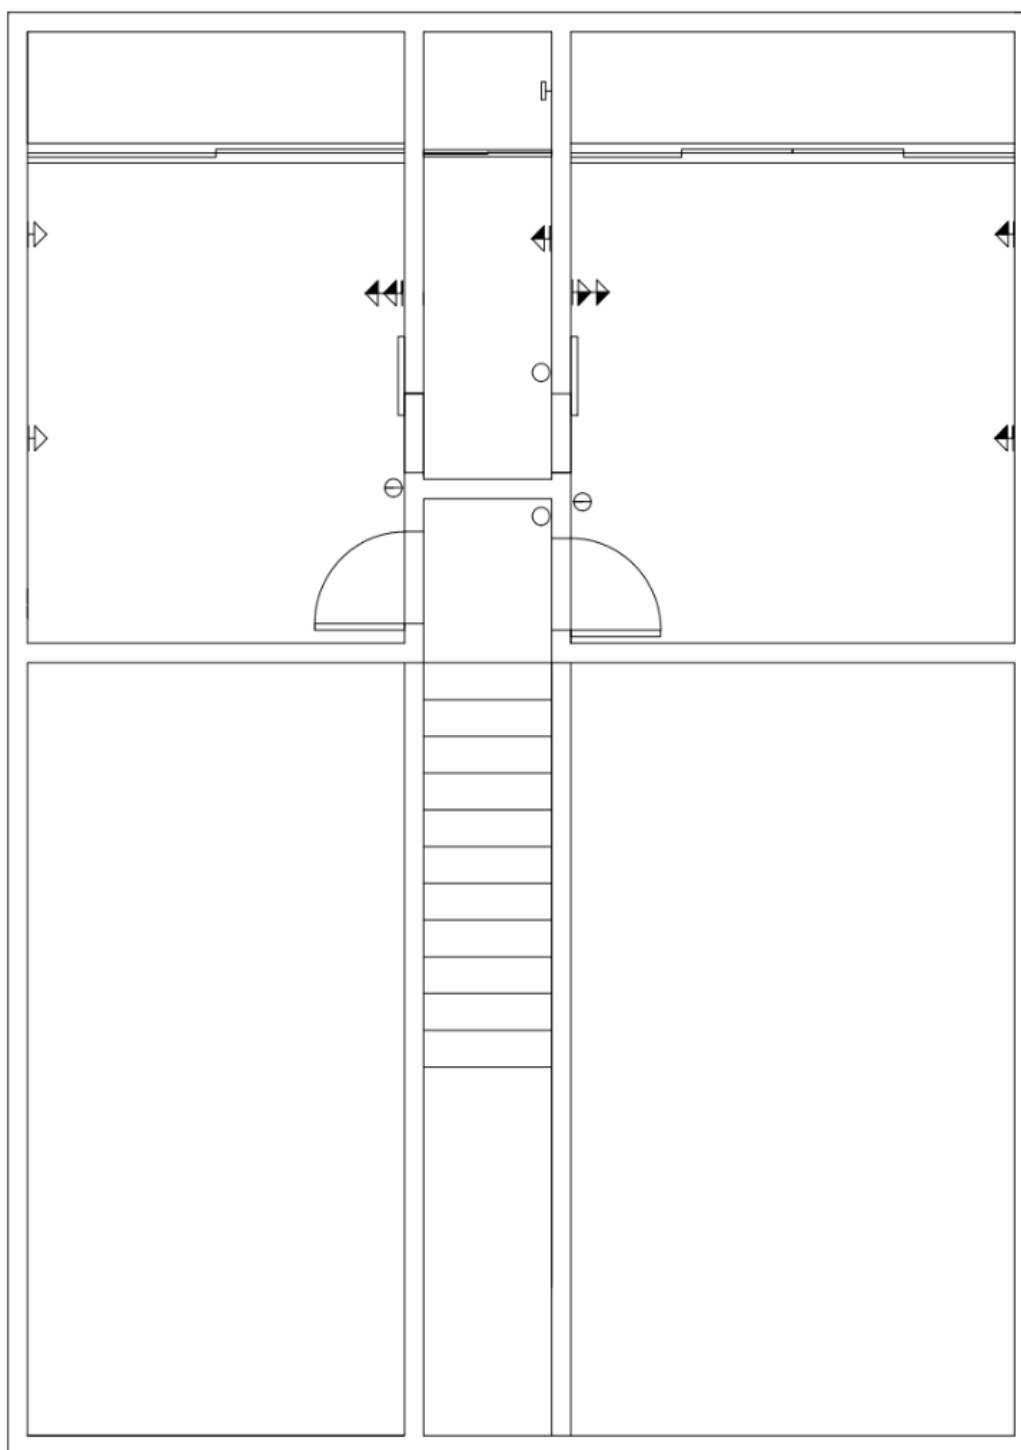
Planta baixa pontos de tomadas e interruptores pavimento superior
